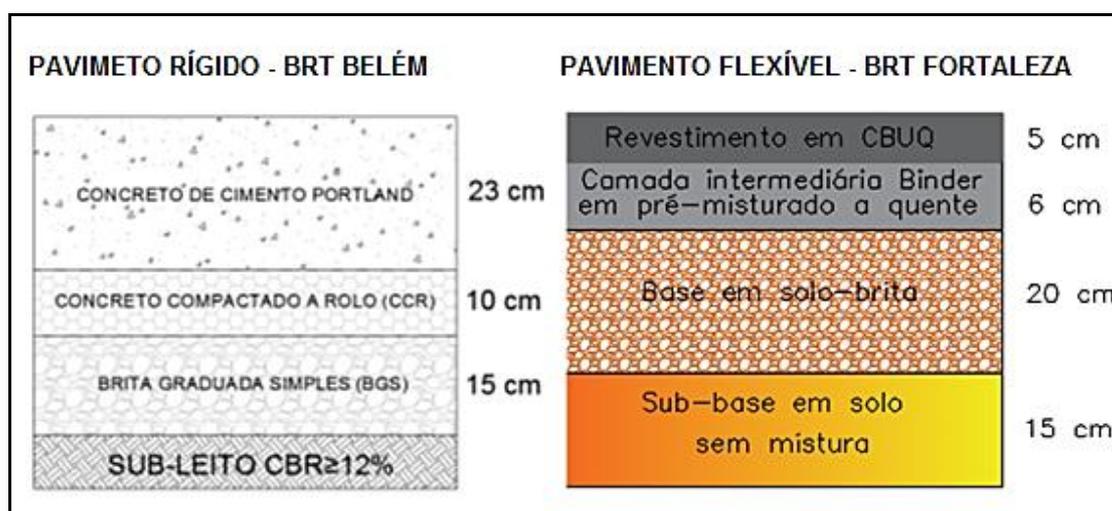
Estrutura esquemática do pavimento rígido e flexível (Silva et al., 2018).
